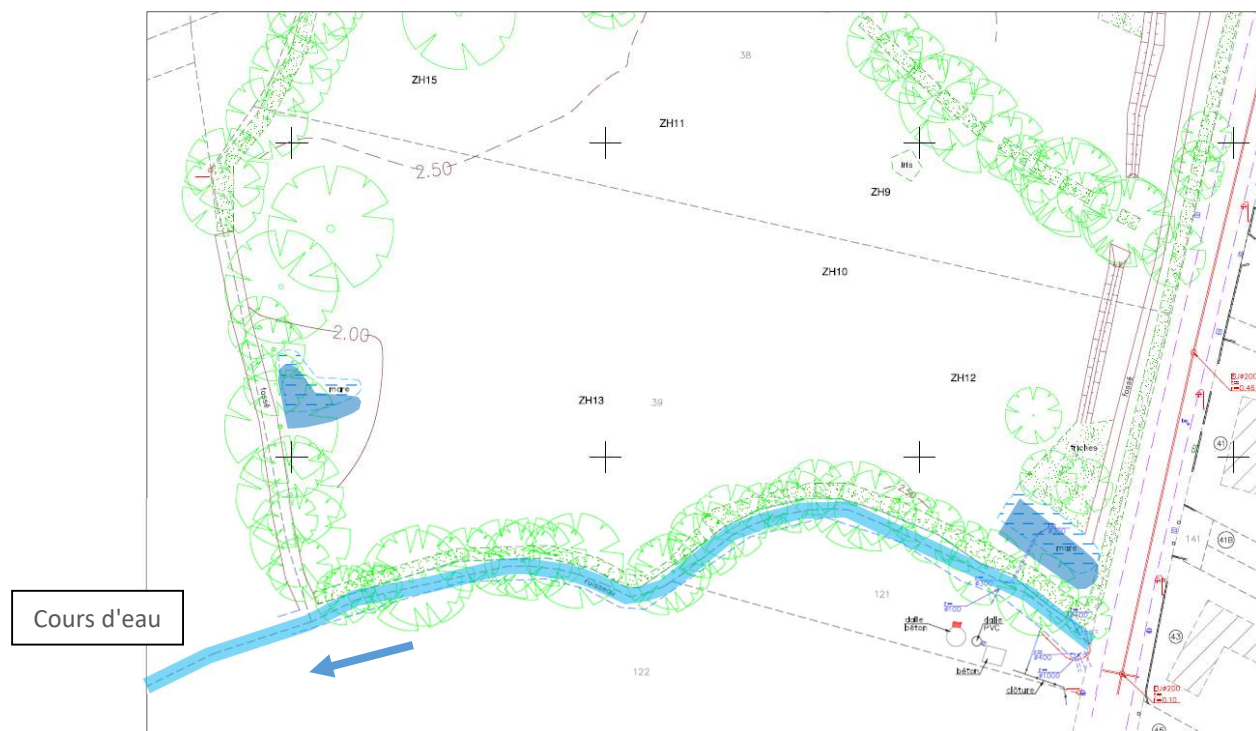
Extrait du plan topographique sur le Sud du site étudié (GEOUEST, sans échelle, 2022)
